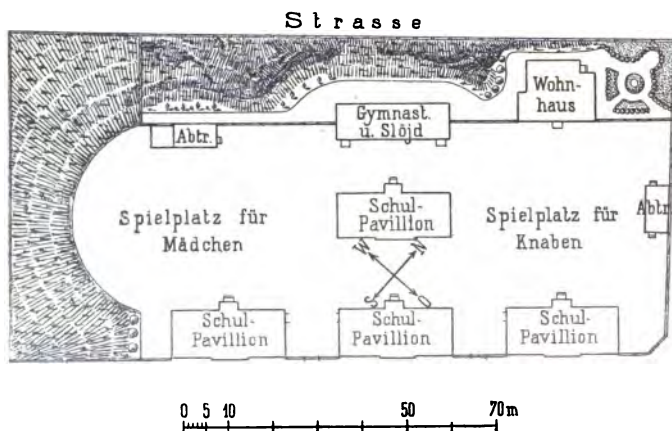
Pavillon-Schulanlage in Drontheim. Situationsplan.
